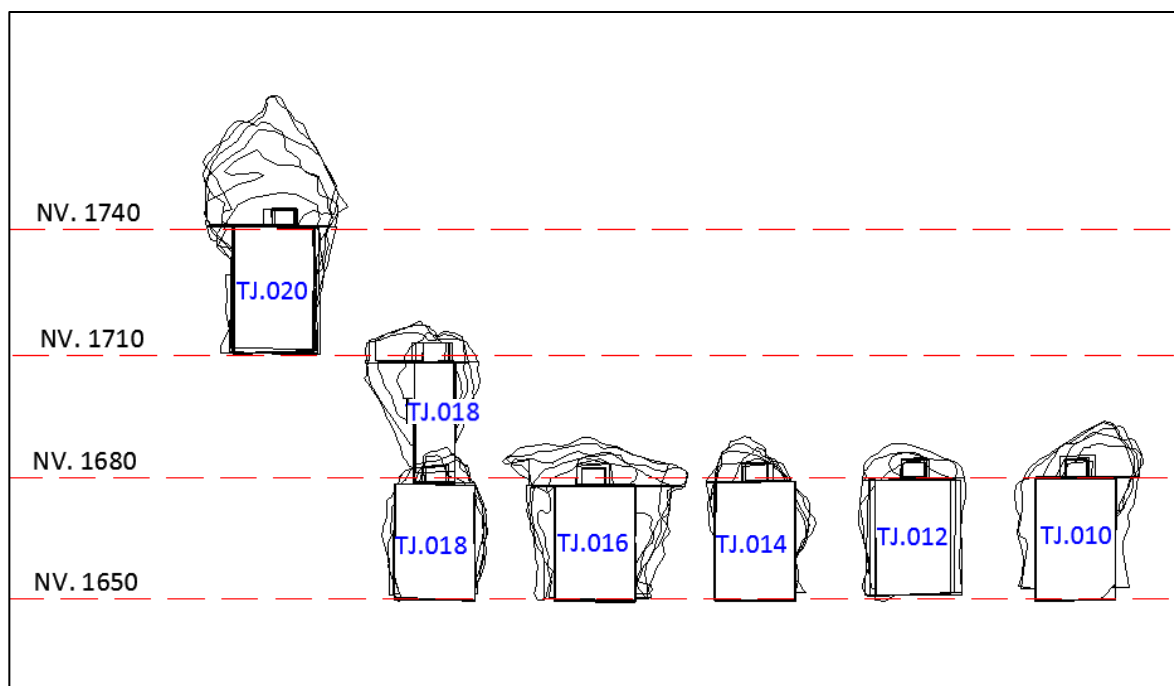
Vista longitudinal del levantamiento de las sobre-excavaciones.
